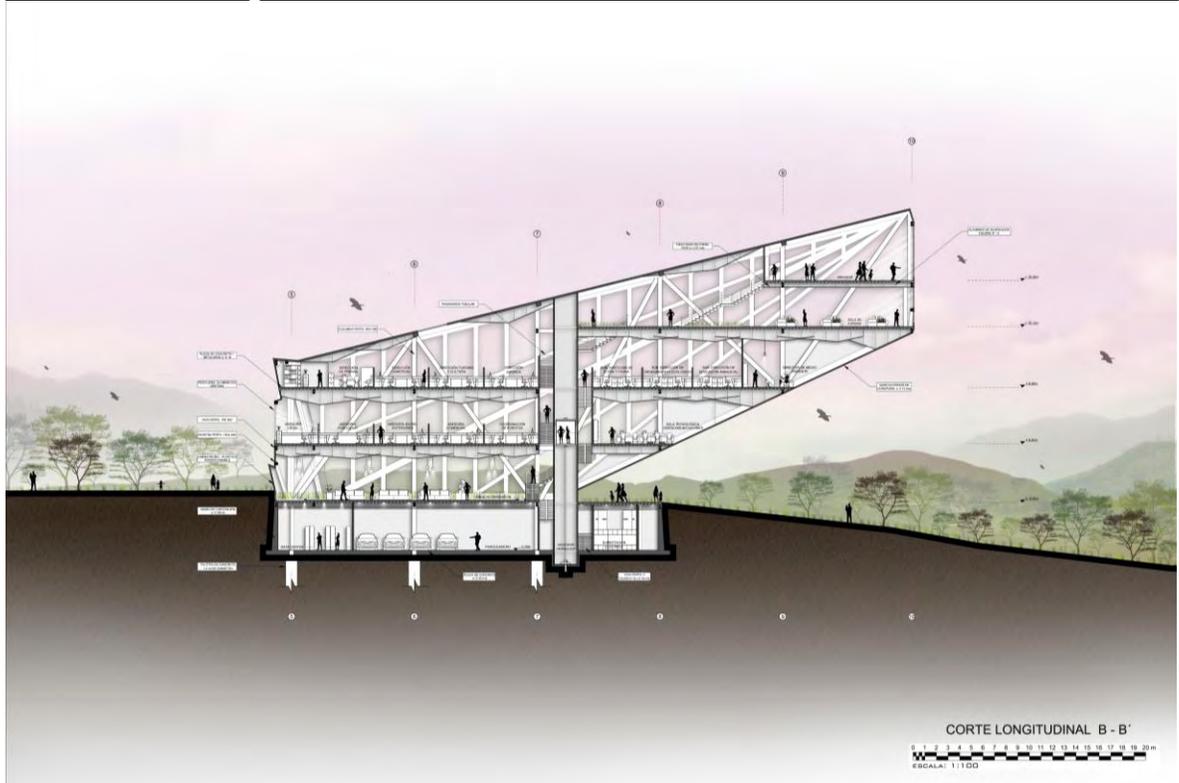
Corte Longitudinal B-B' . Fuente: Elaboración propia
